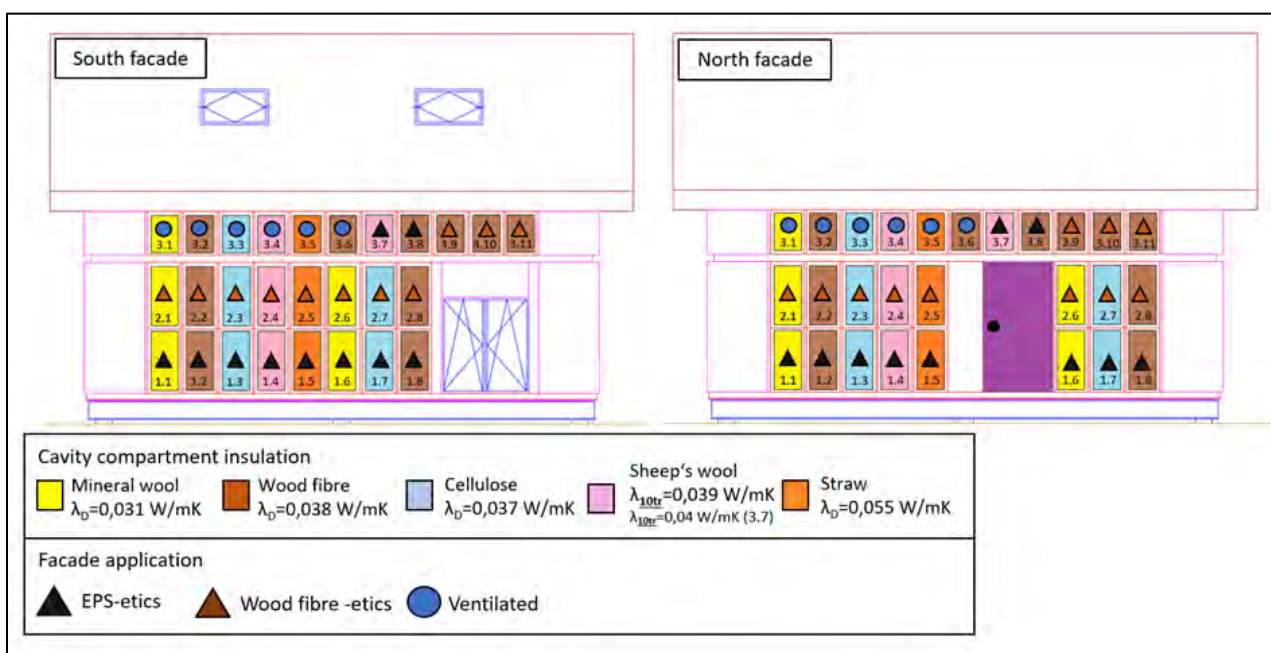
Fassadenansichten Süd- und Nord mit Elementnummern sowie Gefachdämmungs- und Fassadenausführungen.
